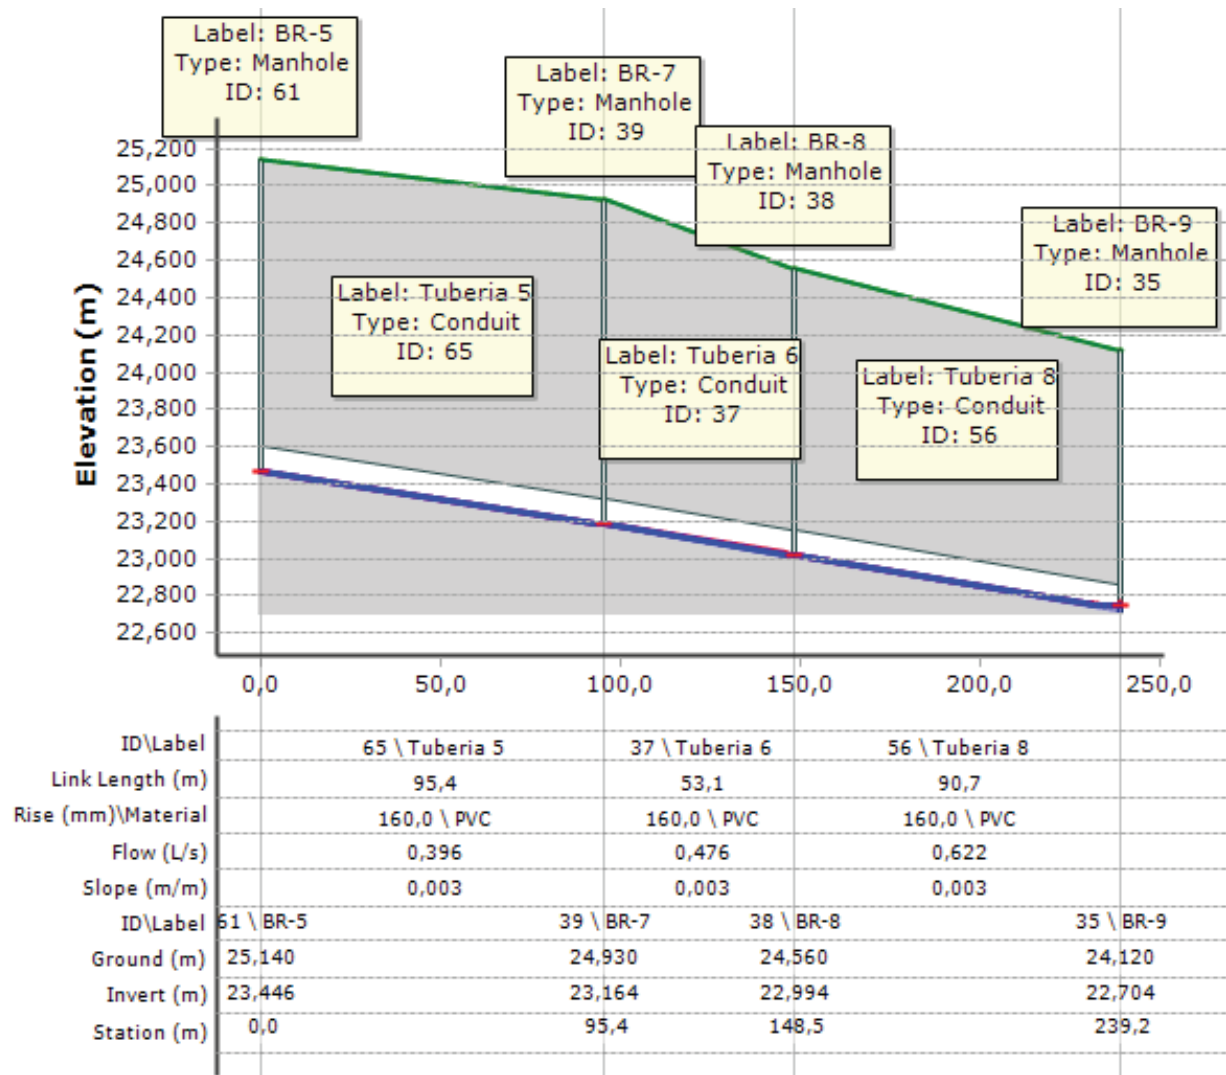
Perfil hidráulico tramo BR-5 a BR-9
